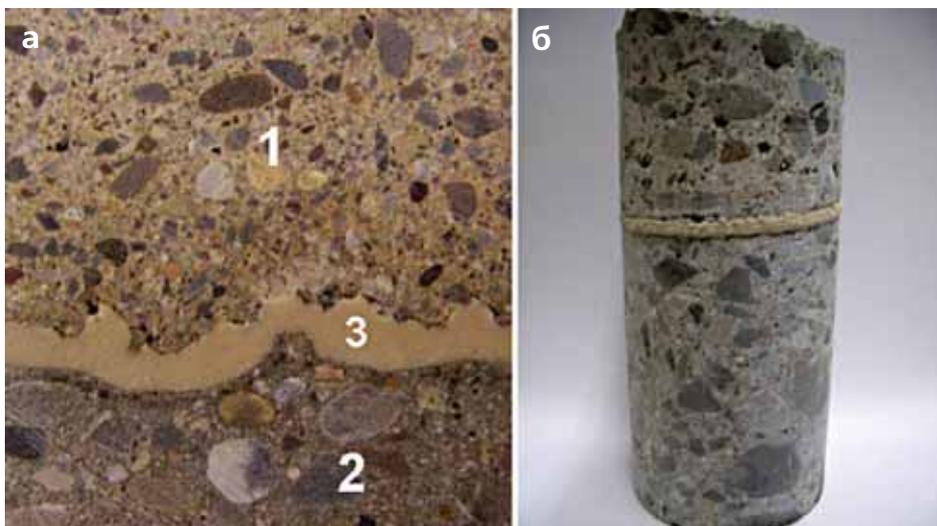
Конструкция обделки: 1 – наружный слой бетона; 2 – внутренний слой; 3 – слой напыляемой гидроизоляции MASTERSEAL 345 (BASF)
